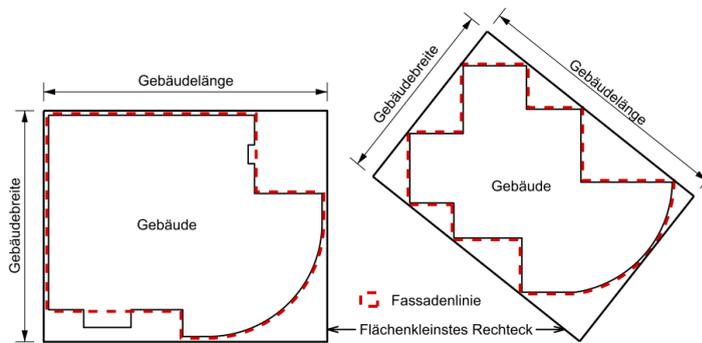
Figur 4.1 und 4.2 Gebäudelänge, Gebäudebreite, IVHB
